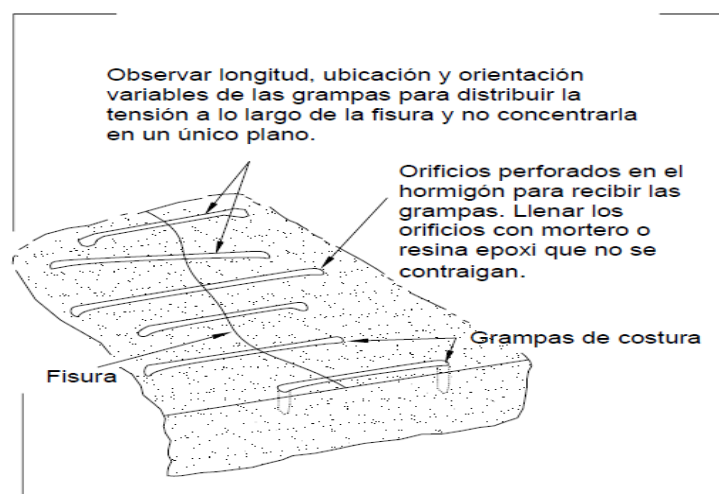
Reparación de una fisura mediante costura.
